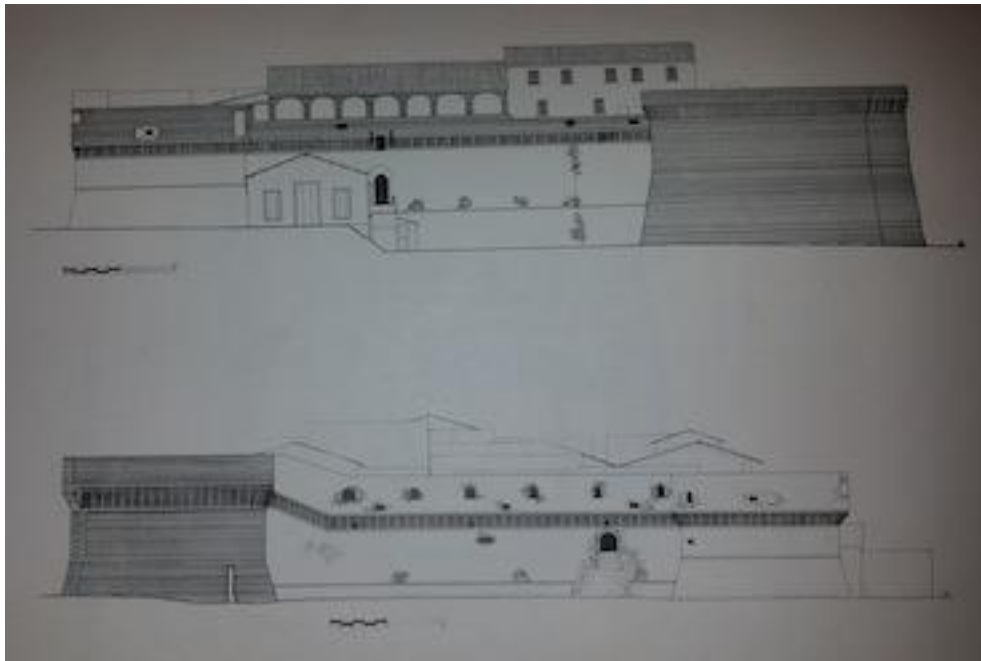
Prospetto Sud e Ovest della Fortezza
